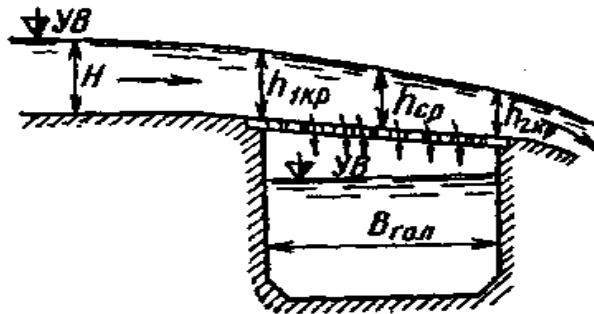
Расчетная схема галереи донного водозабора
